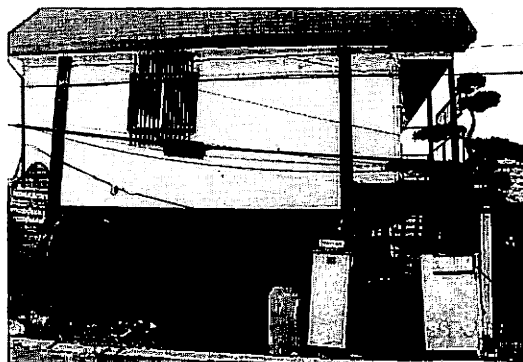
軽量S造2階建て住宅の1階（ピロティ）柱の大変形
